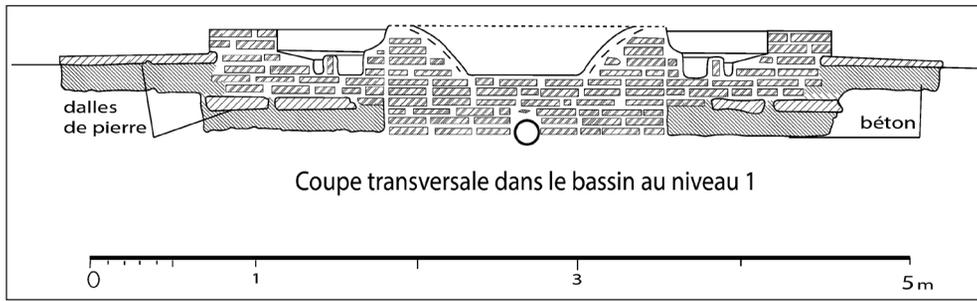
Coupe transversale dans les fondations du premier bassin, (Meunié, Terrasse et Deverdun, *Nouvelles recherches*, 1954, p.14, fig. 6).
